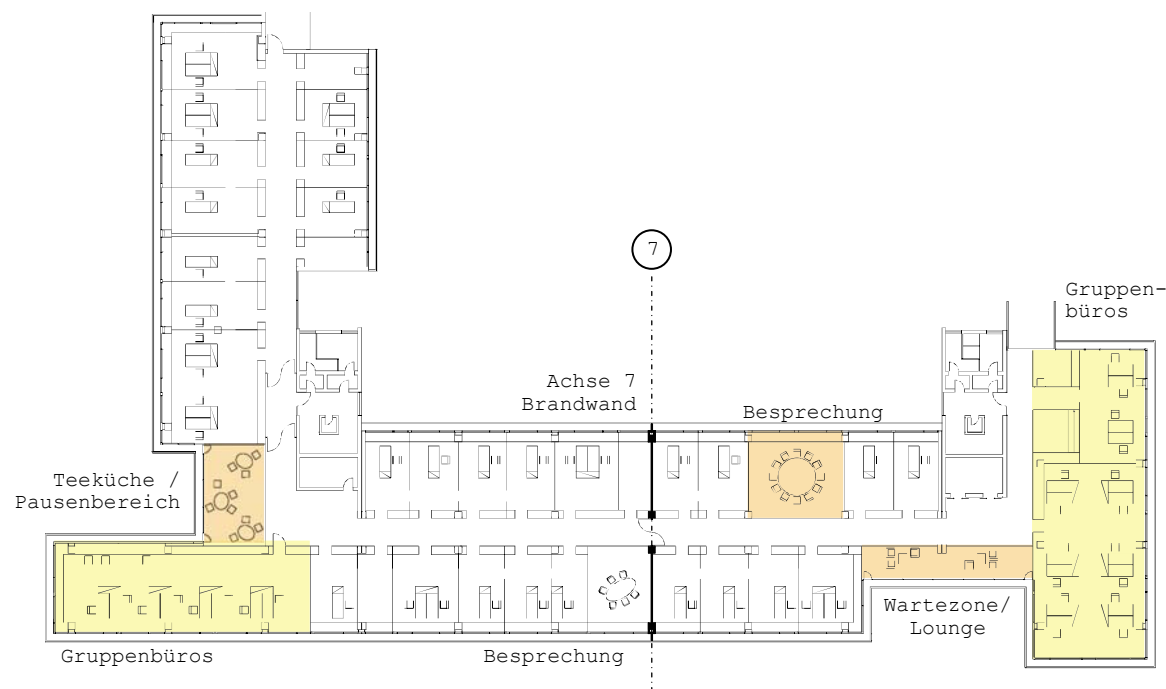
Grundriss Variante 1 mit Gruppenbüros - 61 Arbeitsplätze
